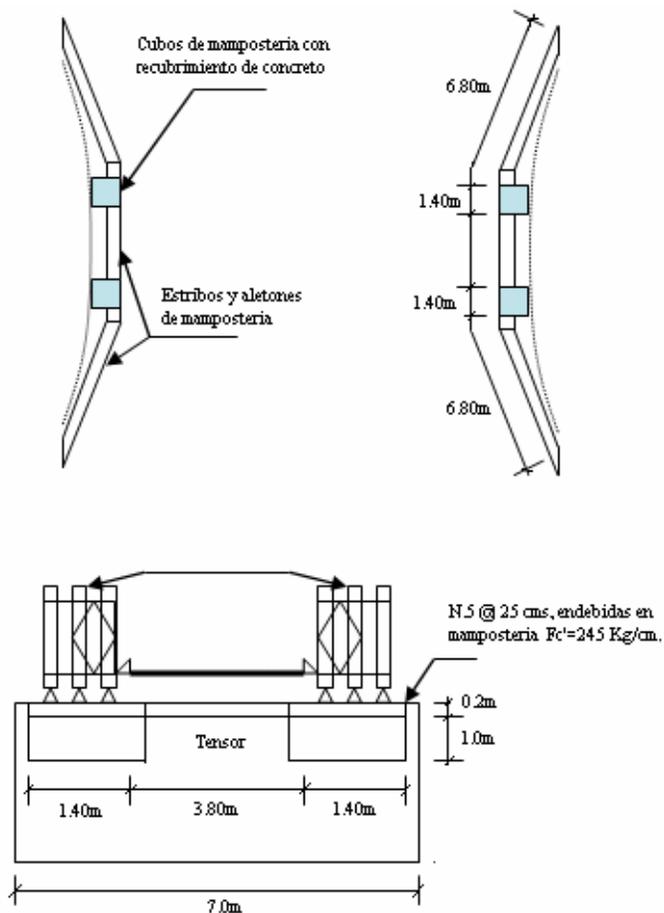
Cubos de mampostería con losa de concreto y tensor de apoyo de puentes metálicos modulares.
